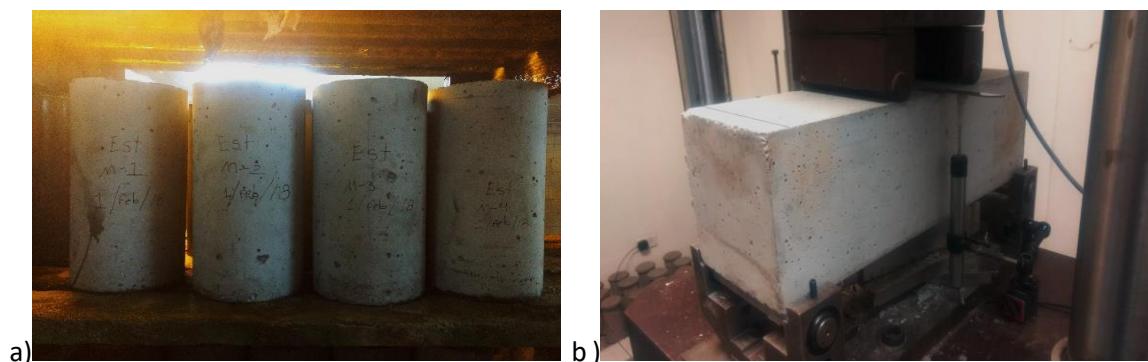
a) Cilindros de concreto b) Vigas de concreto.
